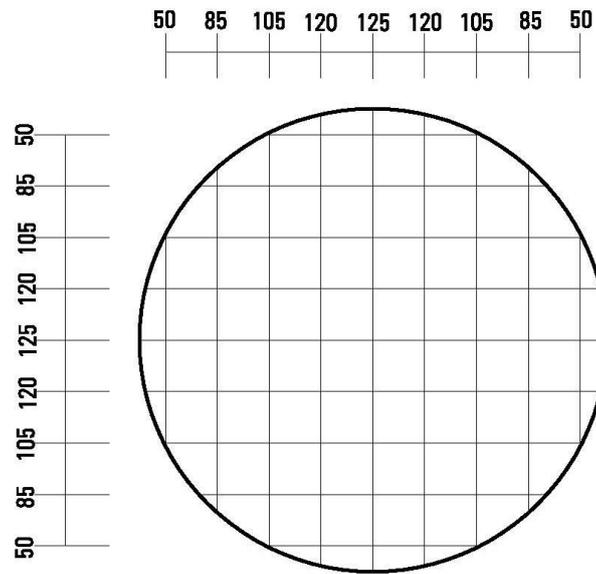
Plan de ferrailage des dalles de latrine SanPlat et DLV
